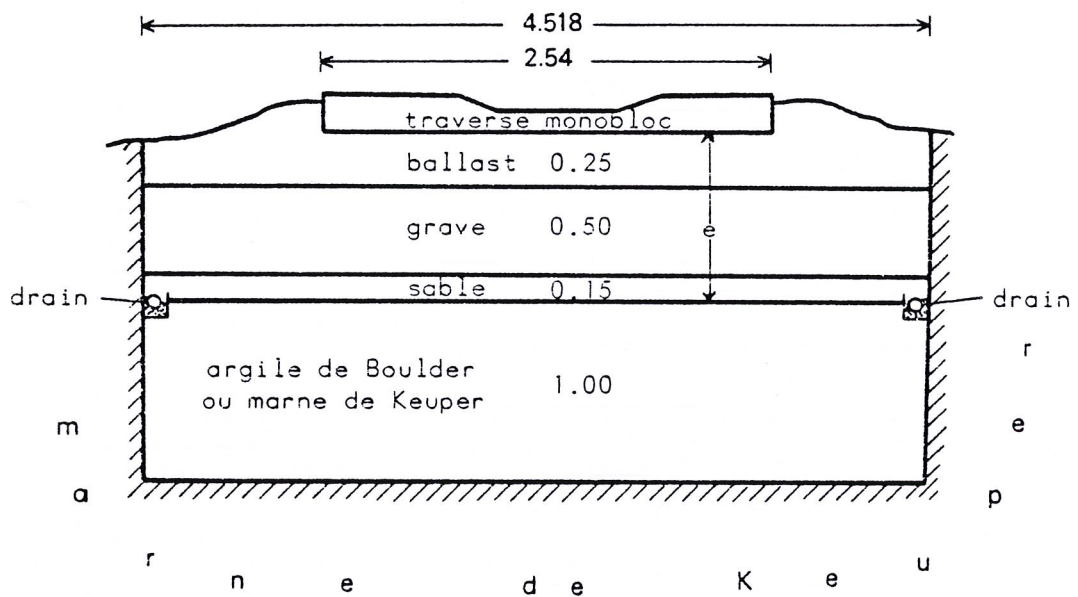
Coupe en travers du site d'essais (cas de la structure 1)
